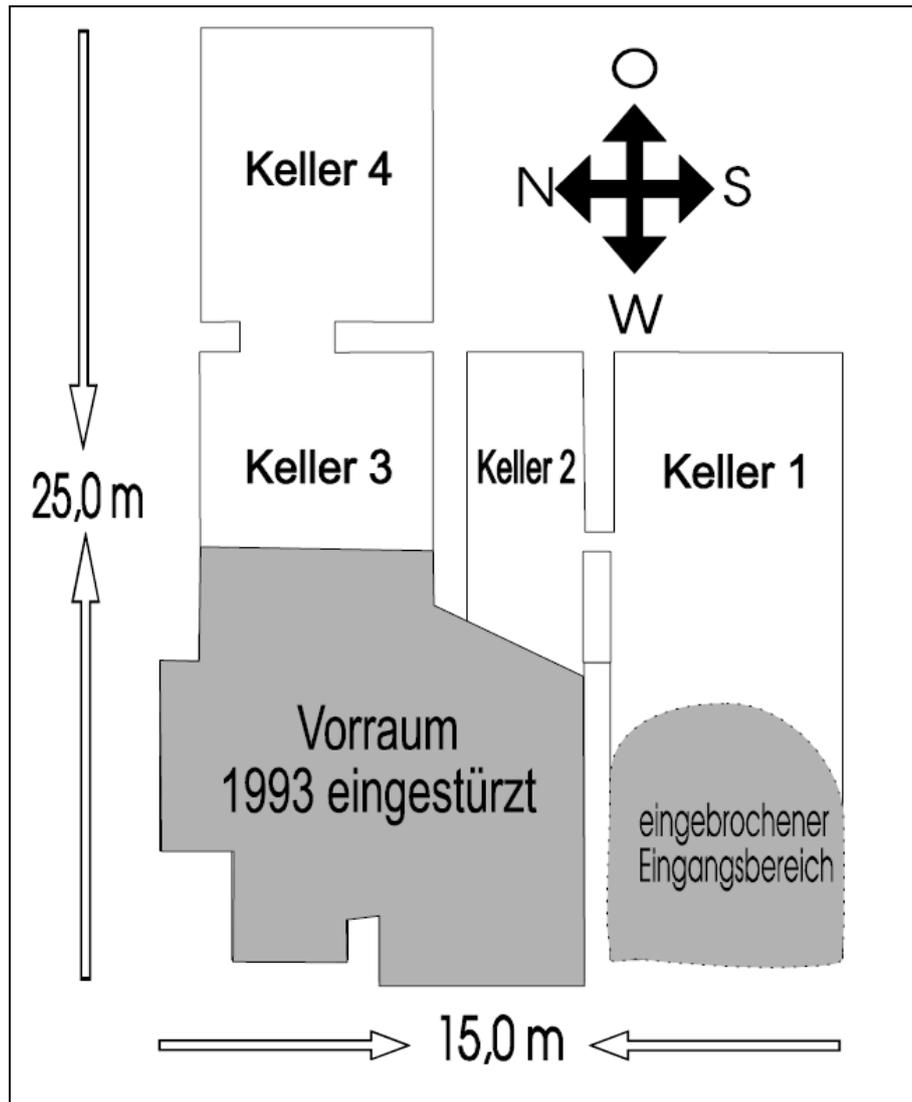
Grundriss-Skizze der Teilfläche 05 „Keller in Trugenhofen“ des FFH-Gebietes 6932-371 (Zeichnung: © Horst Schwark)
